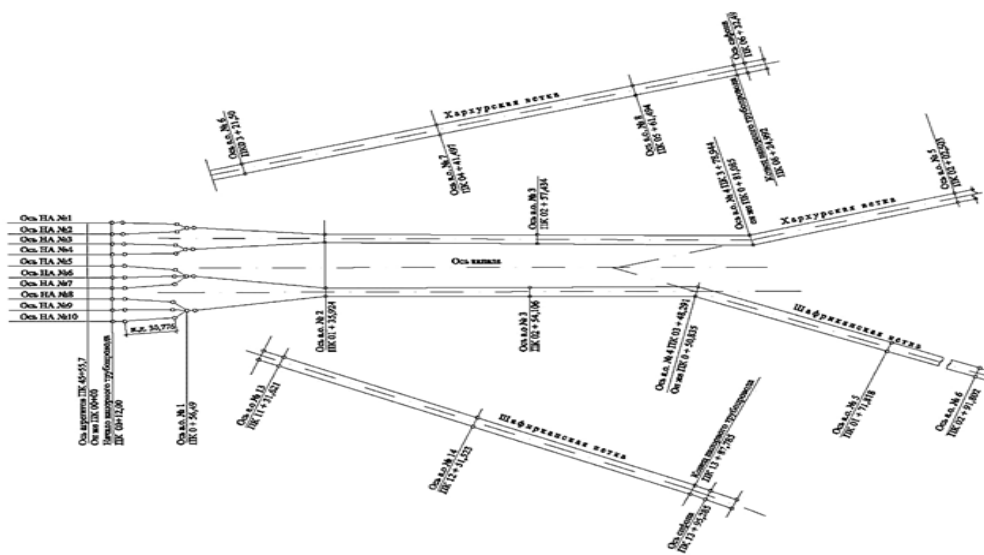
План-схема напорных трубопроводов насосной станции «Кизилтепа»
